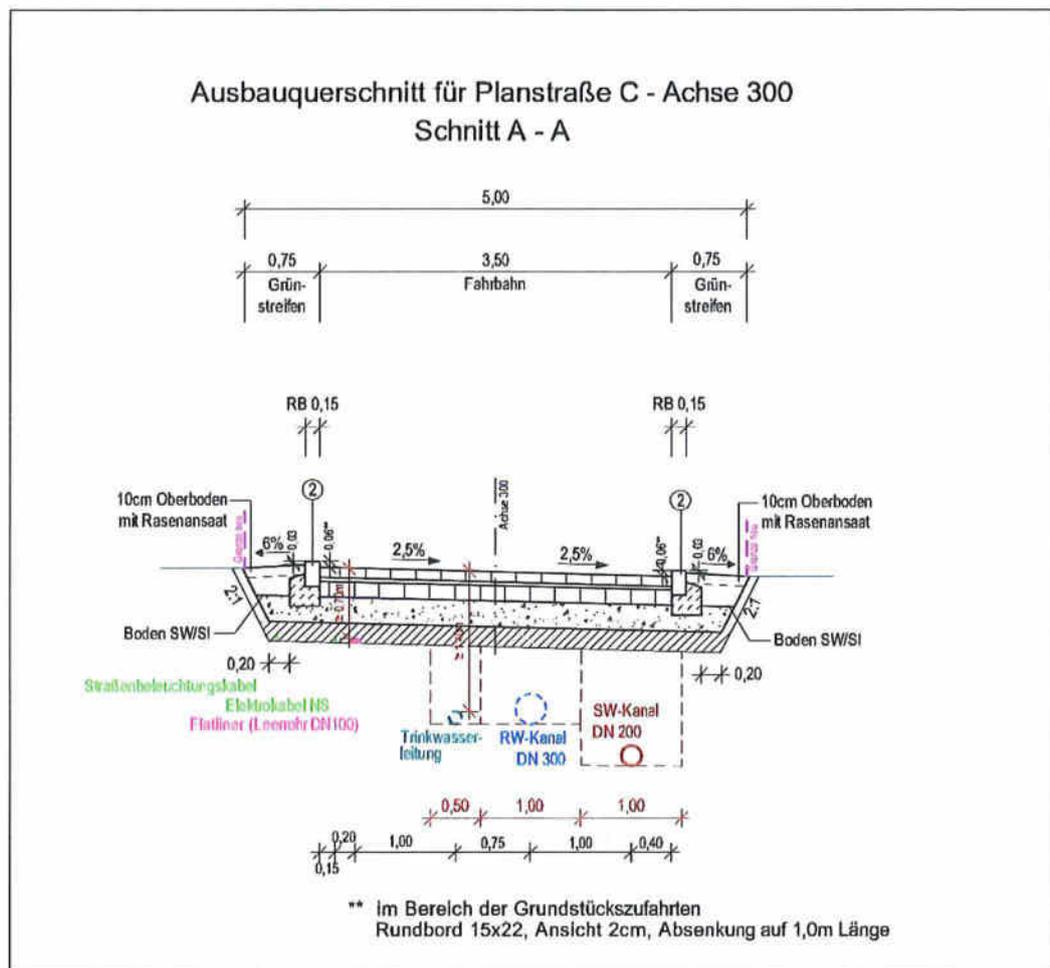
Empfehlung für den Straßenquerschnitt – Regelquerschnitt (Planstraße C) (Quelle: Ausführungsplanung, IBL Schwerin –Ingenieurbüro Leirich, Stand: 11/2022)
